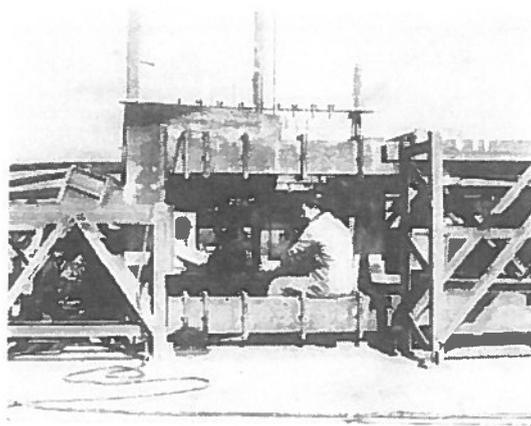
Dispositivo de tracção dos cabos — Estruturas laterais
